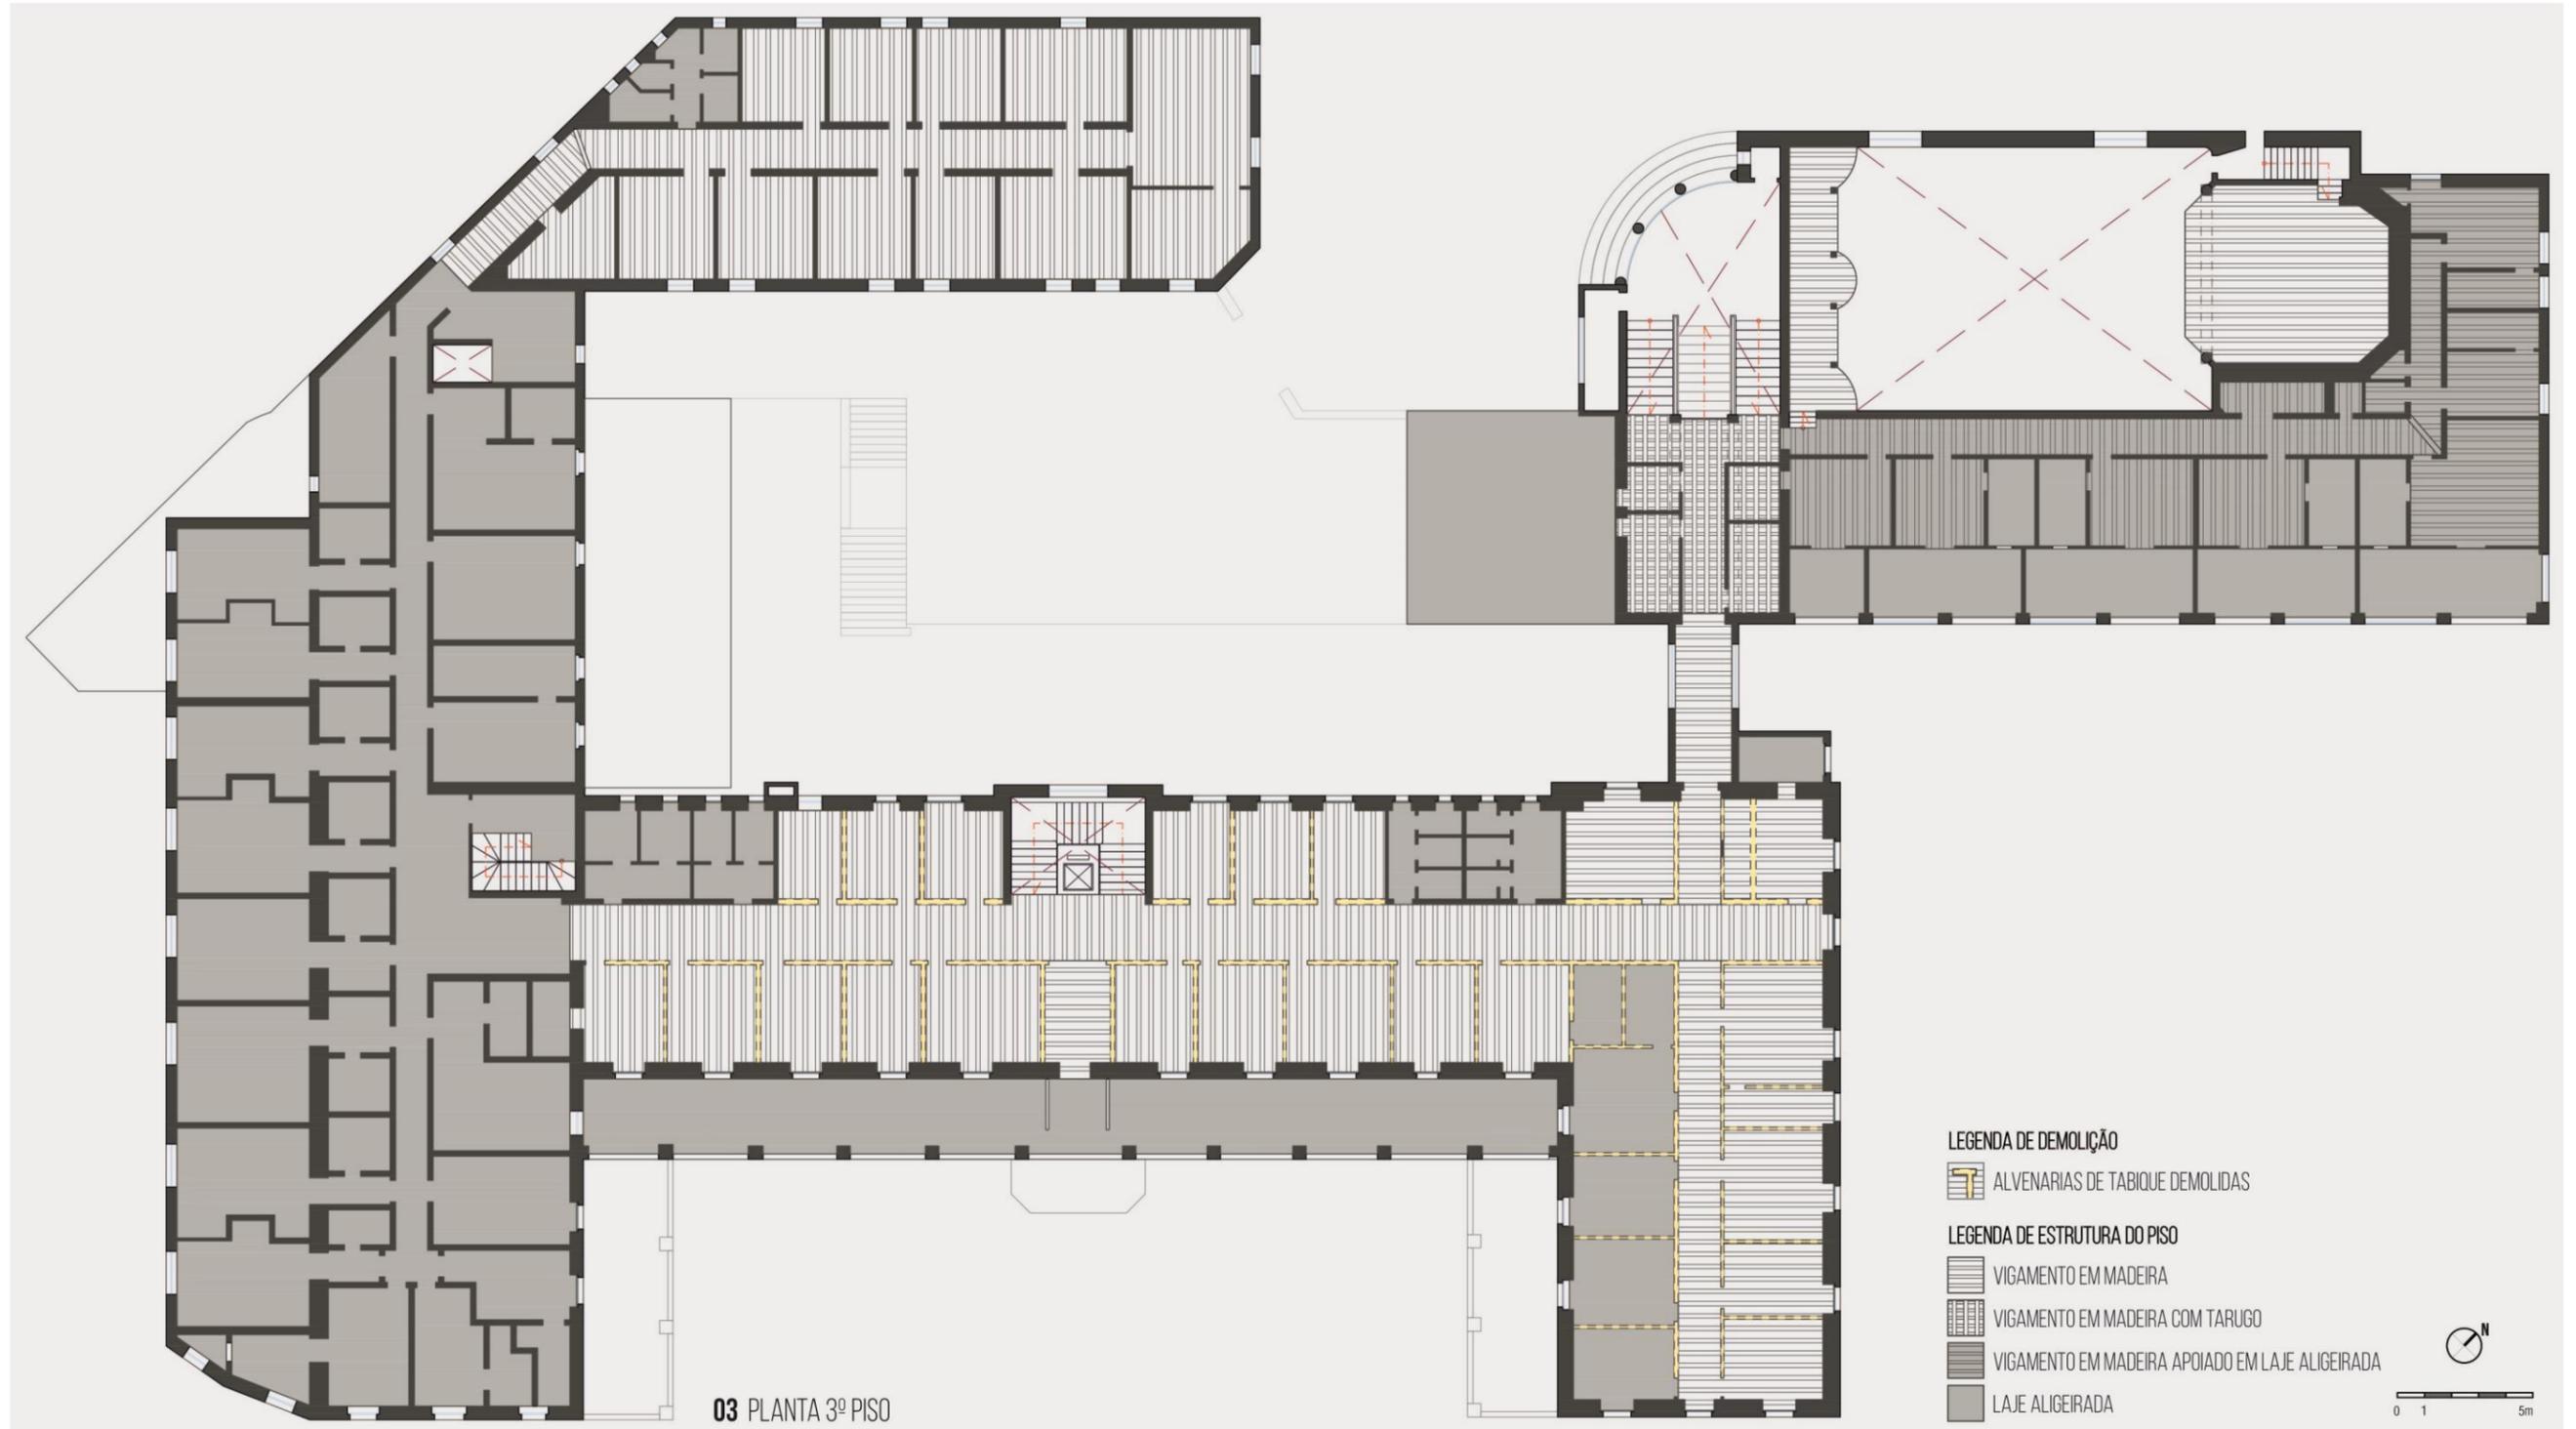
Planta de Estrutura do Pavimento – 3º Piso
